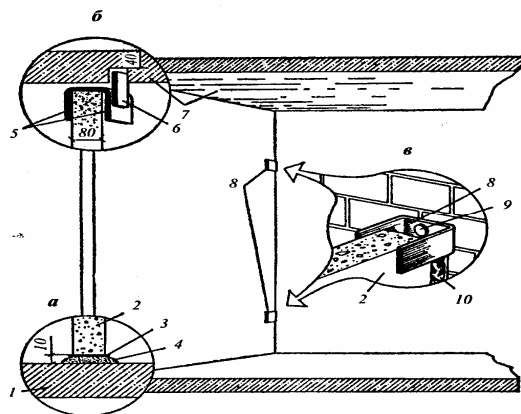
Опираение перегородки на междуэтажное перекрытие (а); сопряжение перегородки с потолком (б); примыкание к стенам (в):
